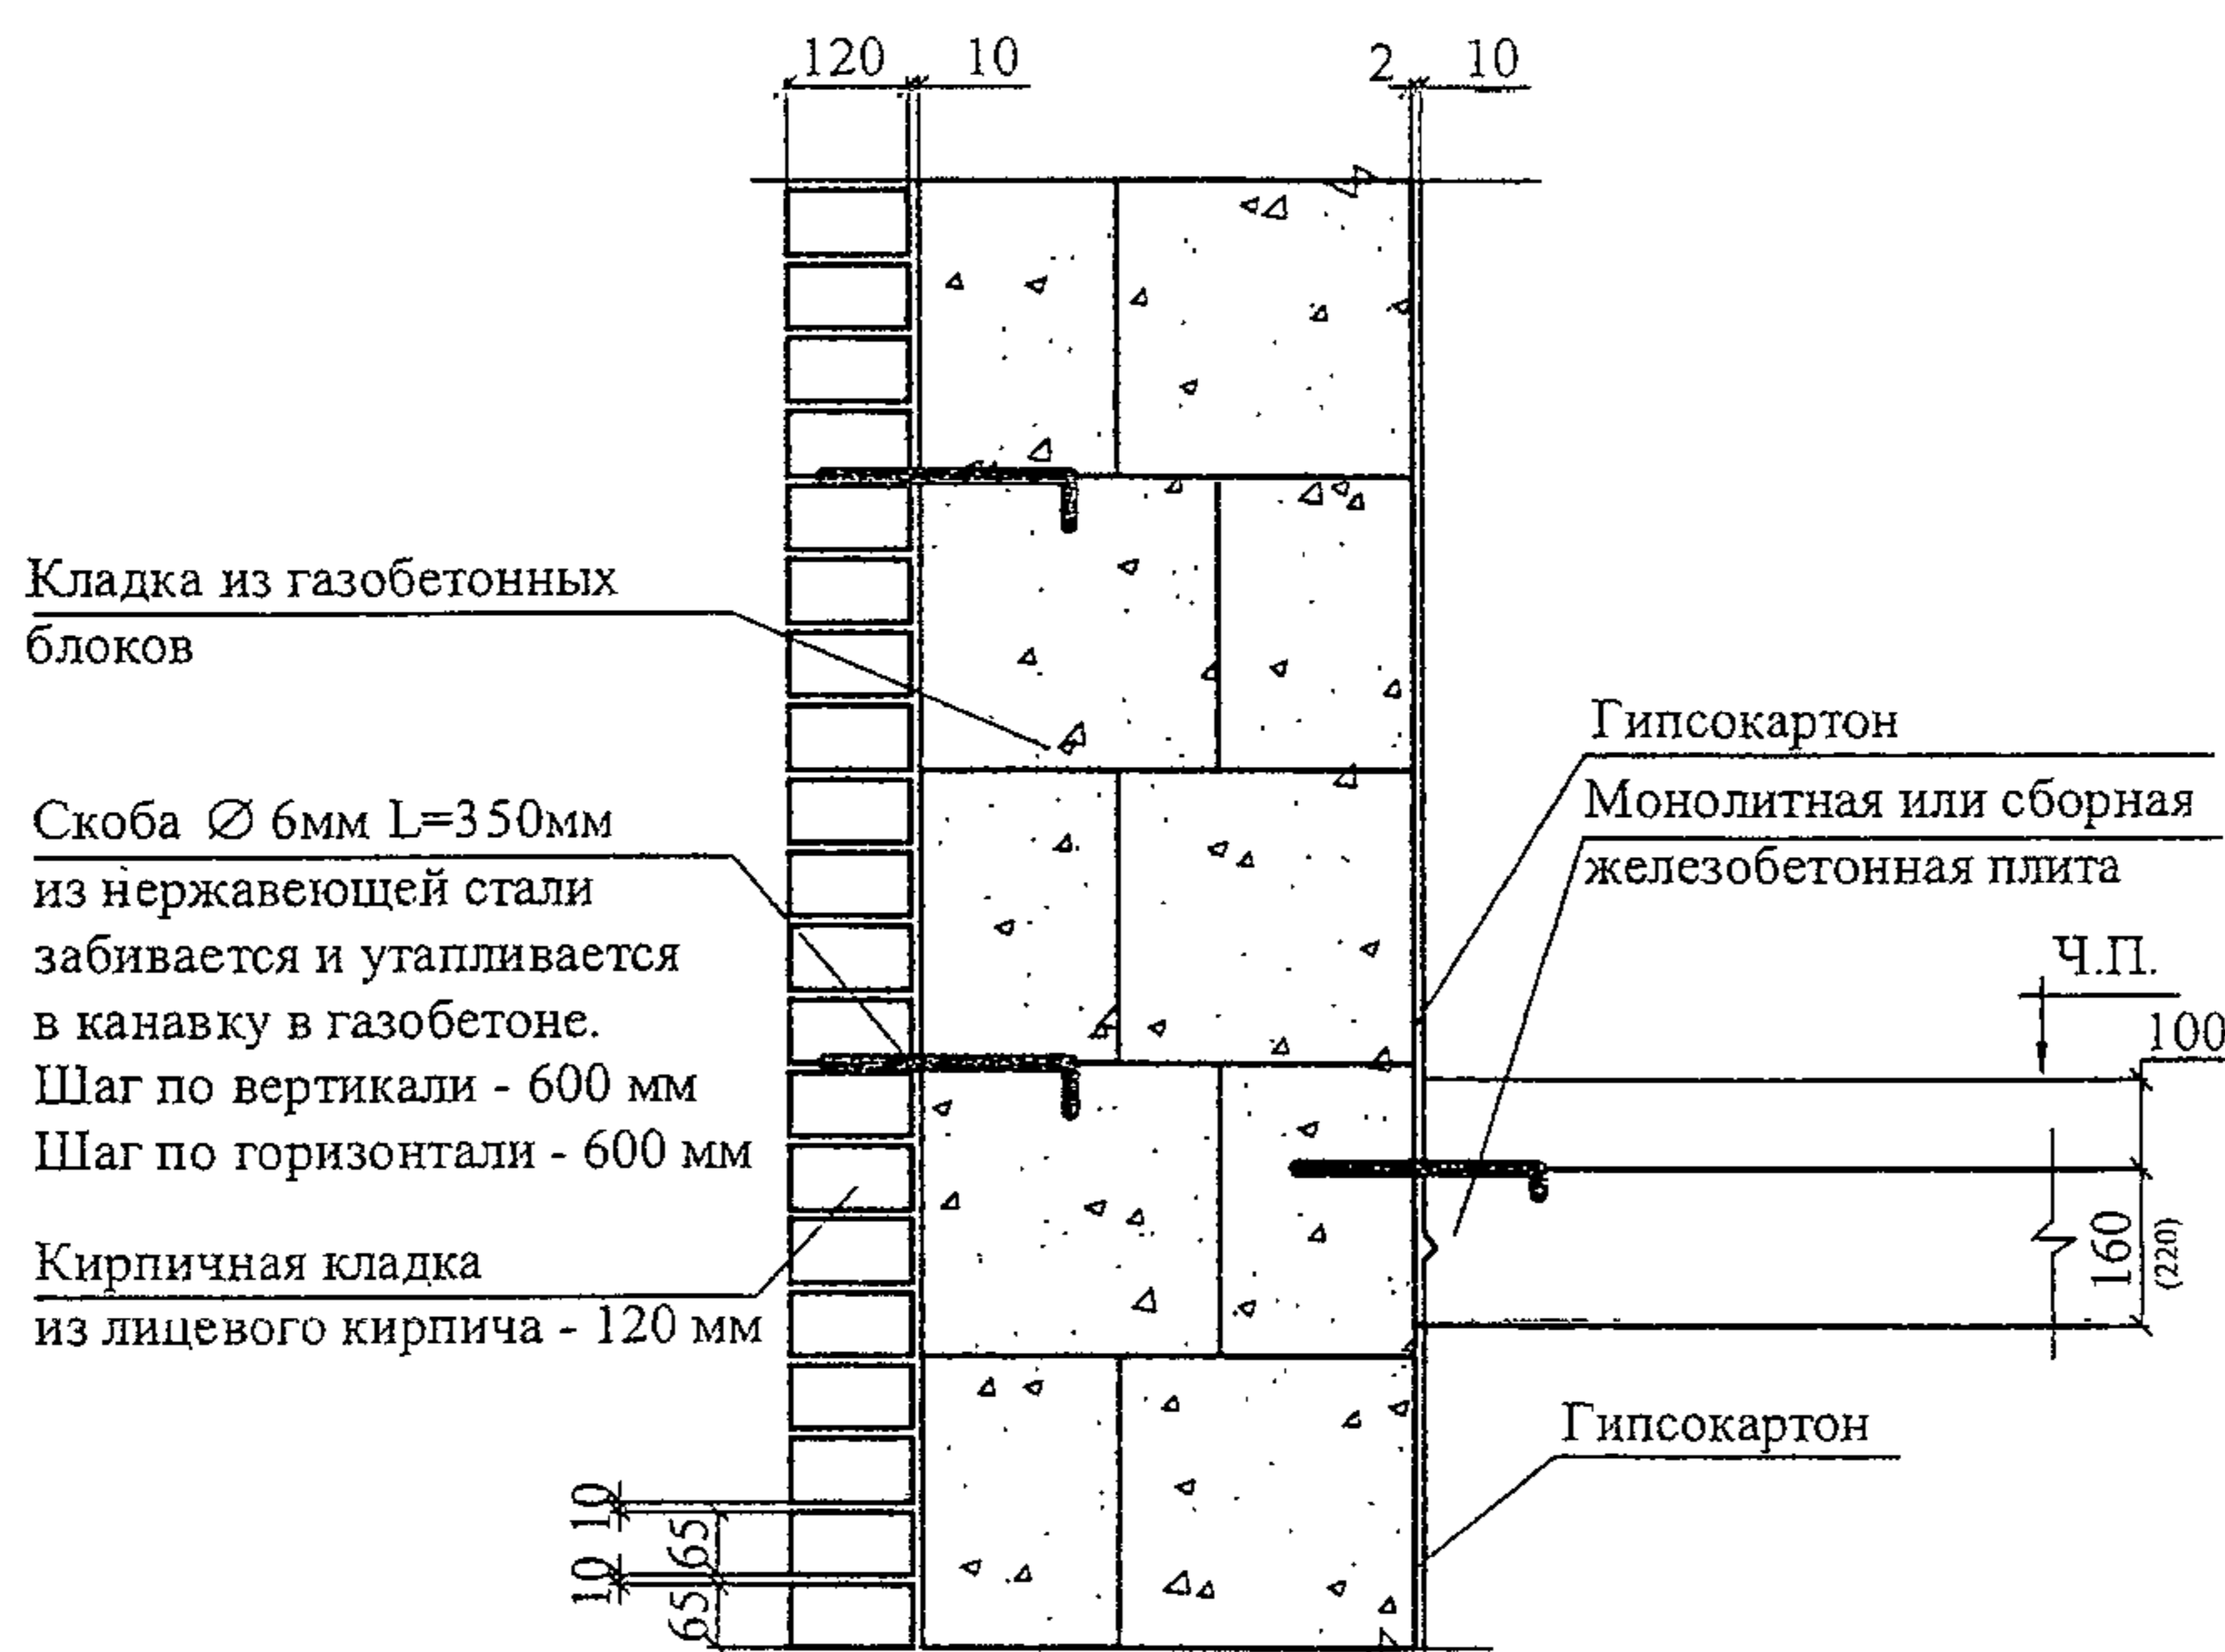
Самонесущая стена из кирпича и газобетонных блоков на клею
